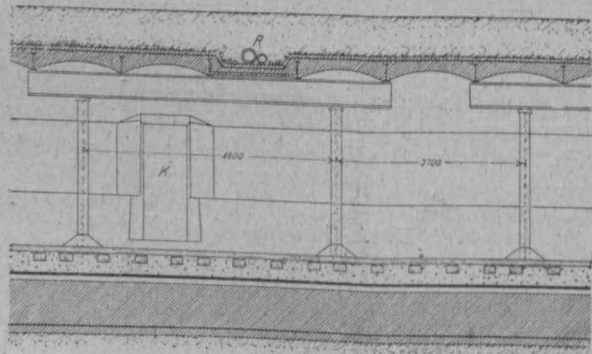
Tunnellängsschnitt (Schönebergbahn) R = Rohrkanal
